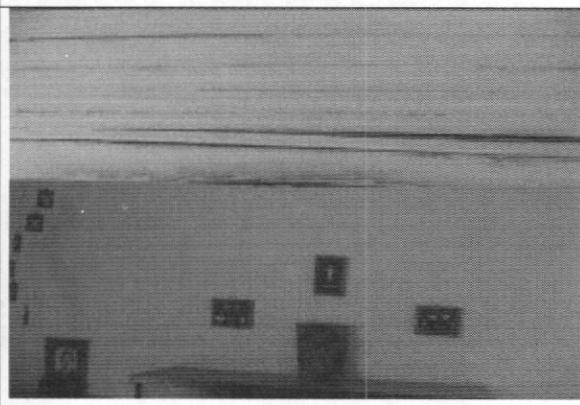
Humedad y deterioro en cielo raso bajo la cubierta
